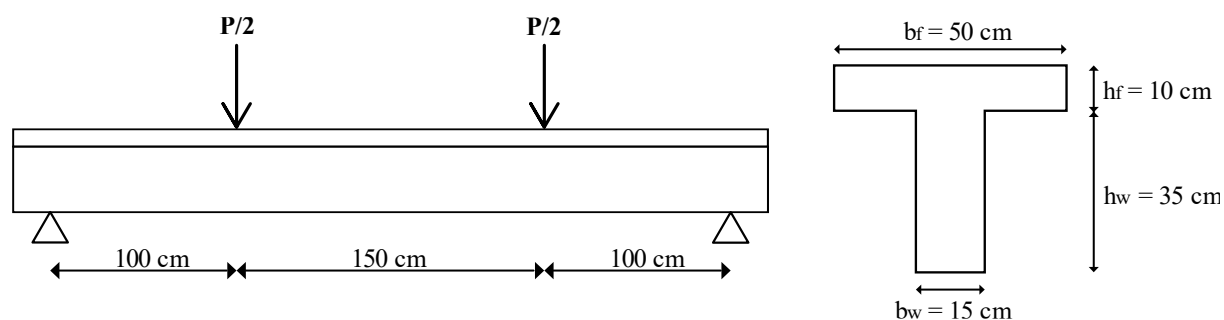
Configuração e seção das vigas estudadas (sem escala).
